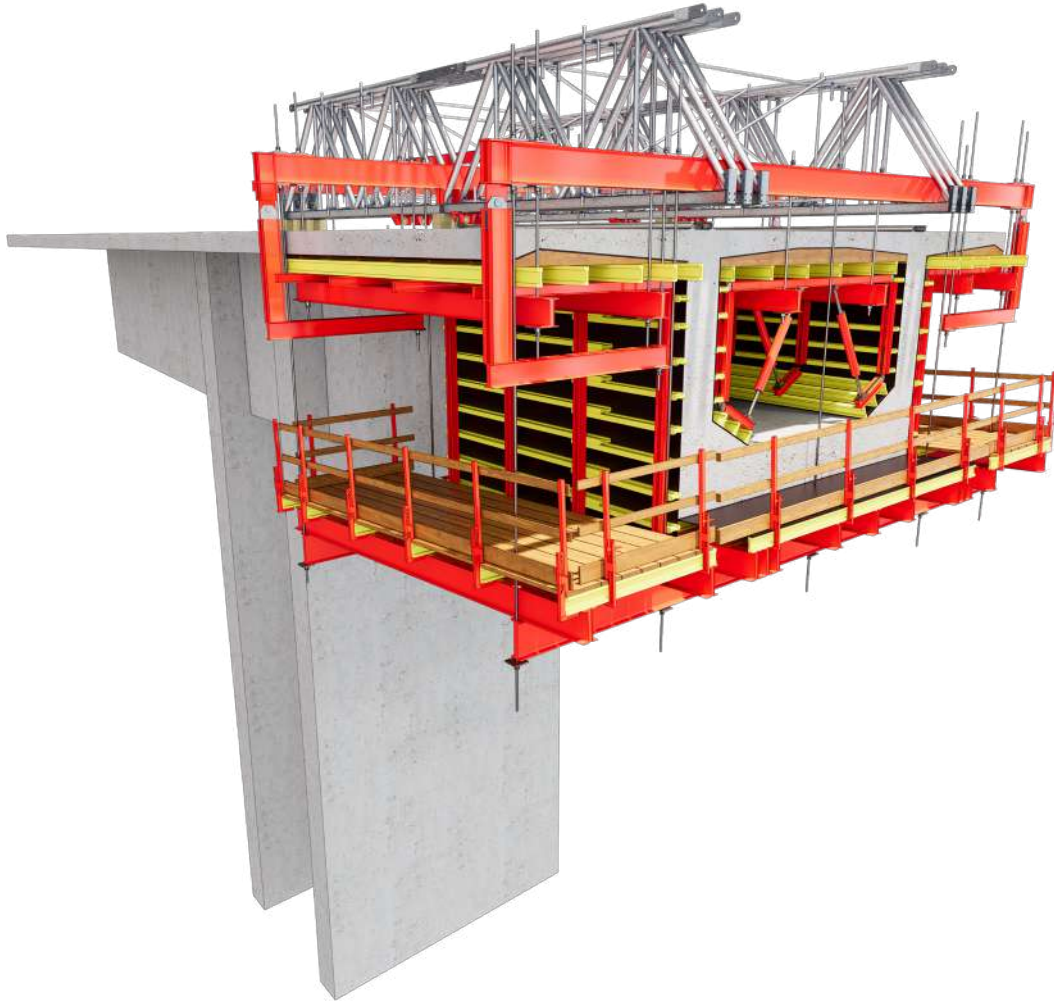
Escoramento de Pontes e Viadutos – Balanço Sucessivo SH
